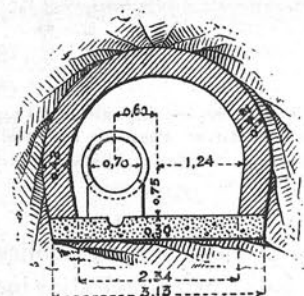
Sección entre los depósitos elevados y calles de Santa Engracia, Abascal al barrio del Lozoya.
